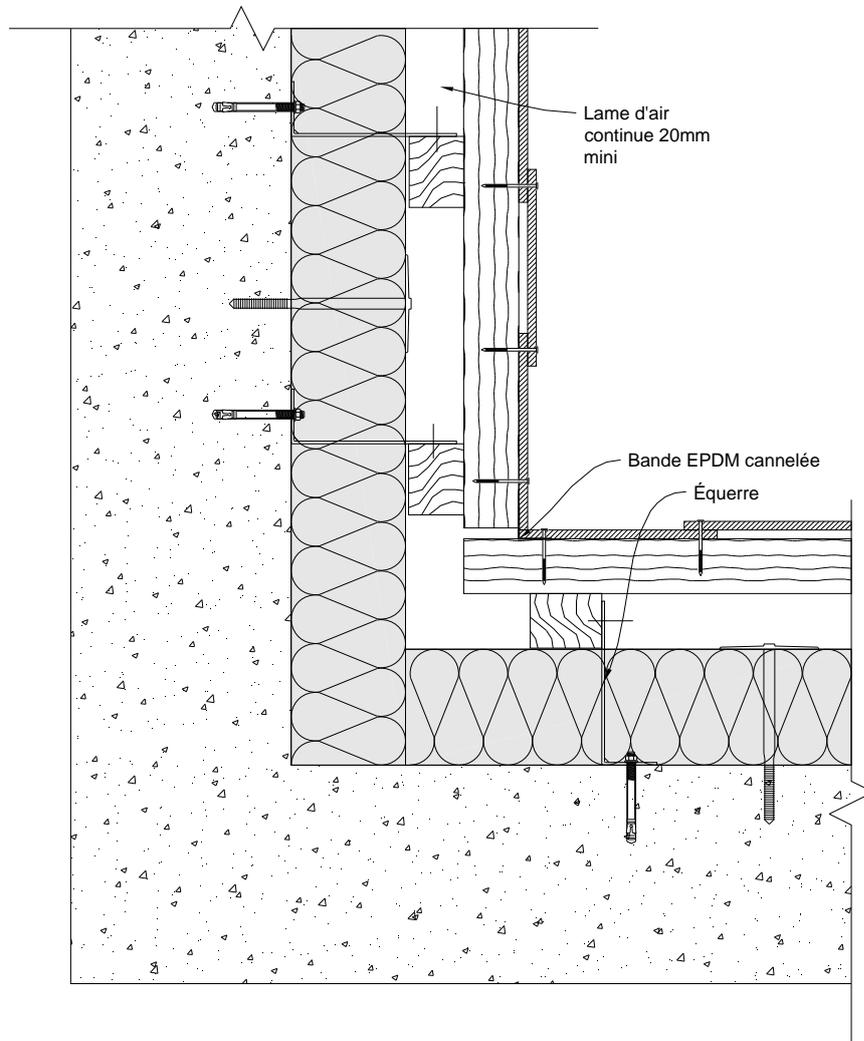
Coupe horizontale angle rentrant clins verticaux – ossature bois
